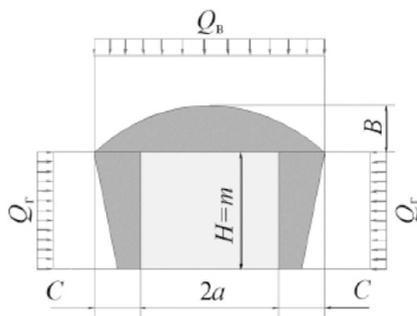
Схема к расчету параметров анкерной крепи (Q_n и Q_r – вертикальная и горизонтальная нагрузка)
